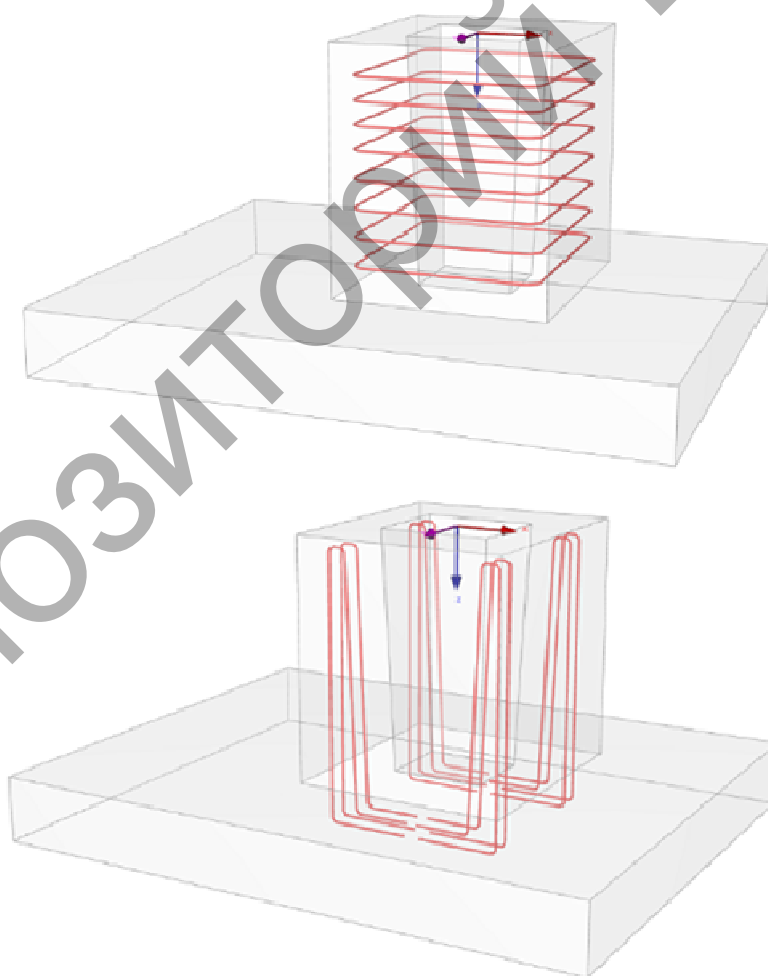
Армирование хомутами и петлями стаканной части фундамента.
